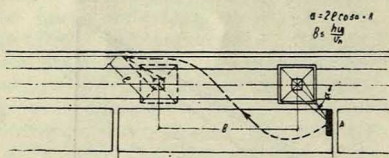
Схема работы блока монтажным краном со складочной площадкой в точке монтажа
